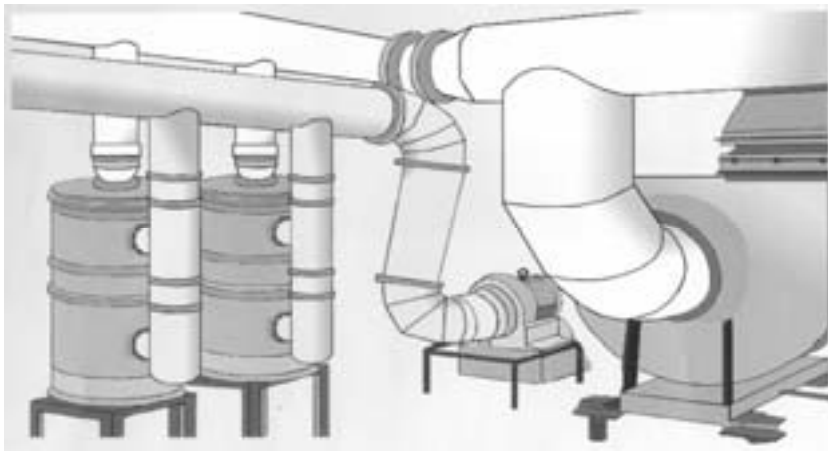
Фільтровентиляційне обладнання (ФВО) сховища.
